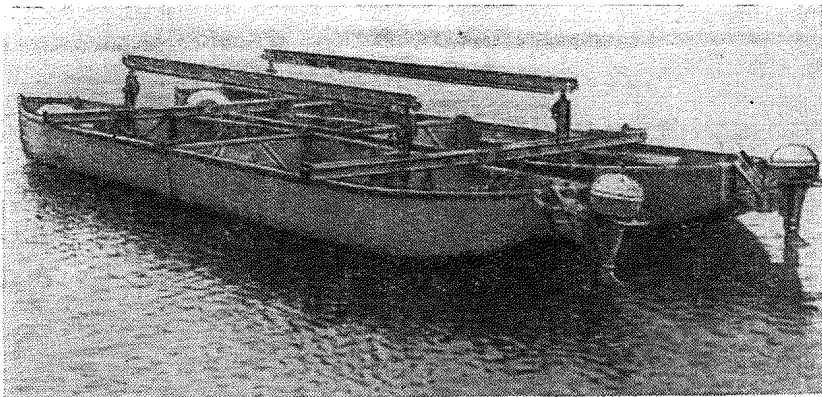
Паром с домкратами в сборе для укладки пролетных строений на опоры
